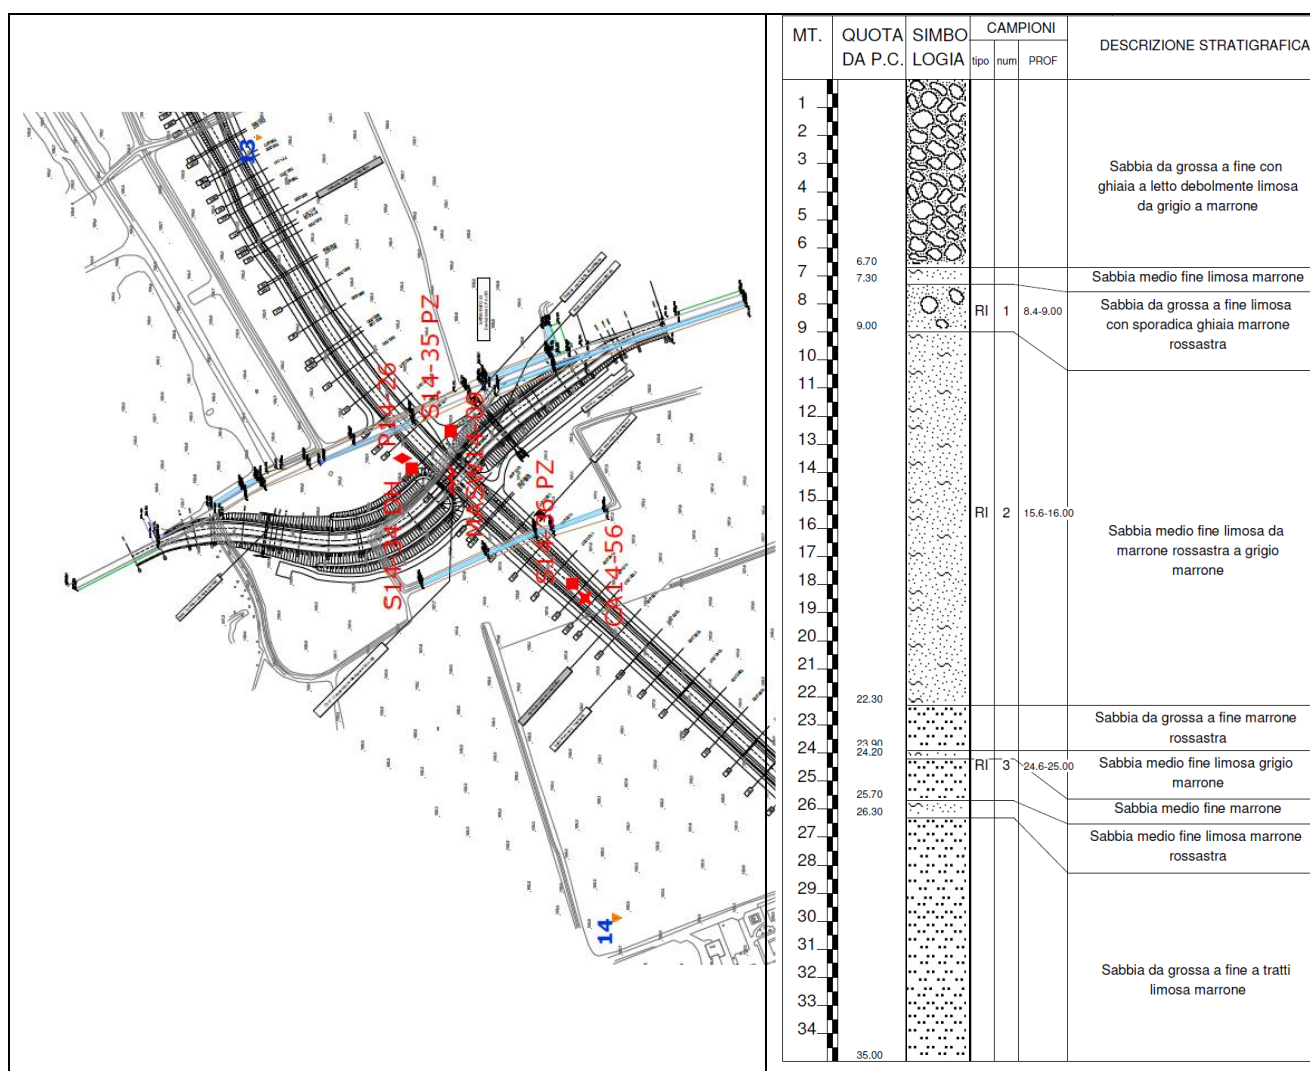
Stralcio planimetrico e stratigrafia sondaggio meccanico S14-34
